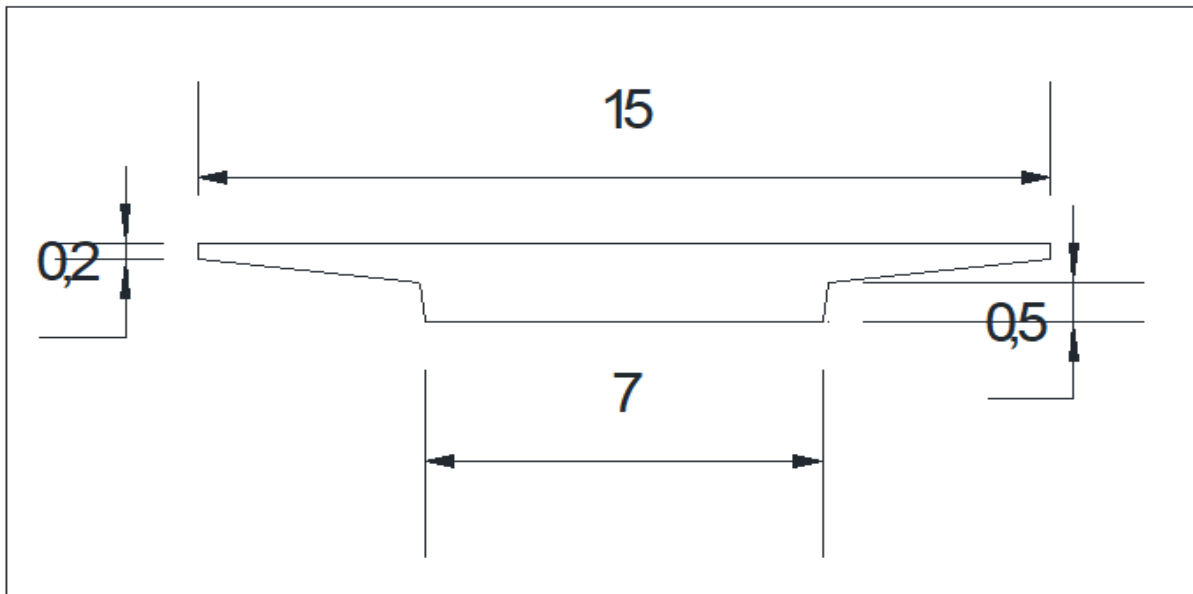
Coupe transversale de la dalle (prédimensionnement).
